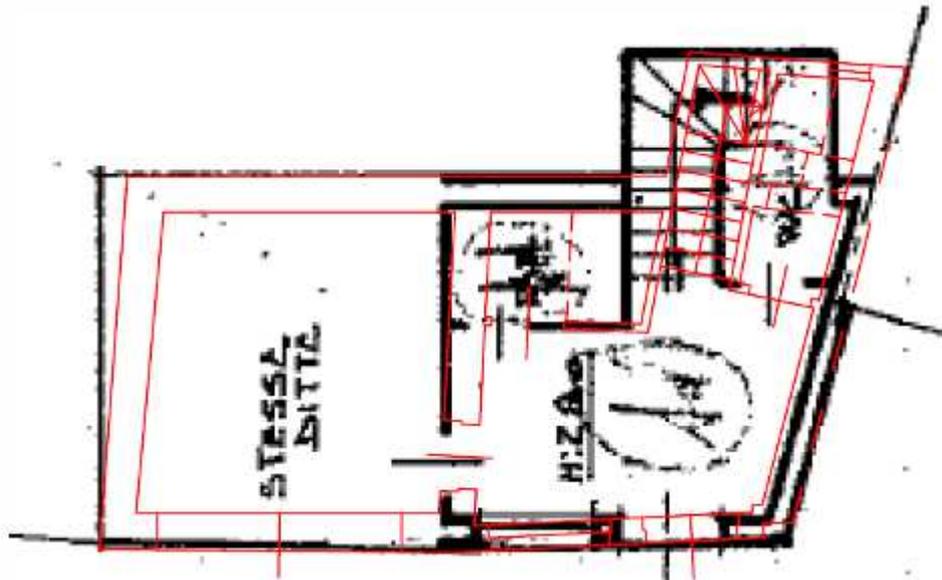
Sovrapposizione tra lo stato attuale - planimetria catastale, sub. 1 (p.1).
